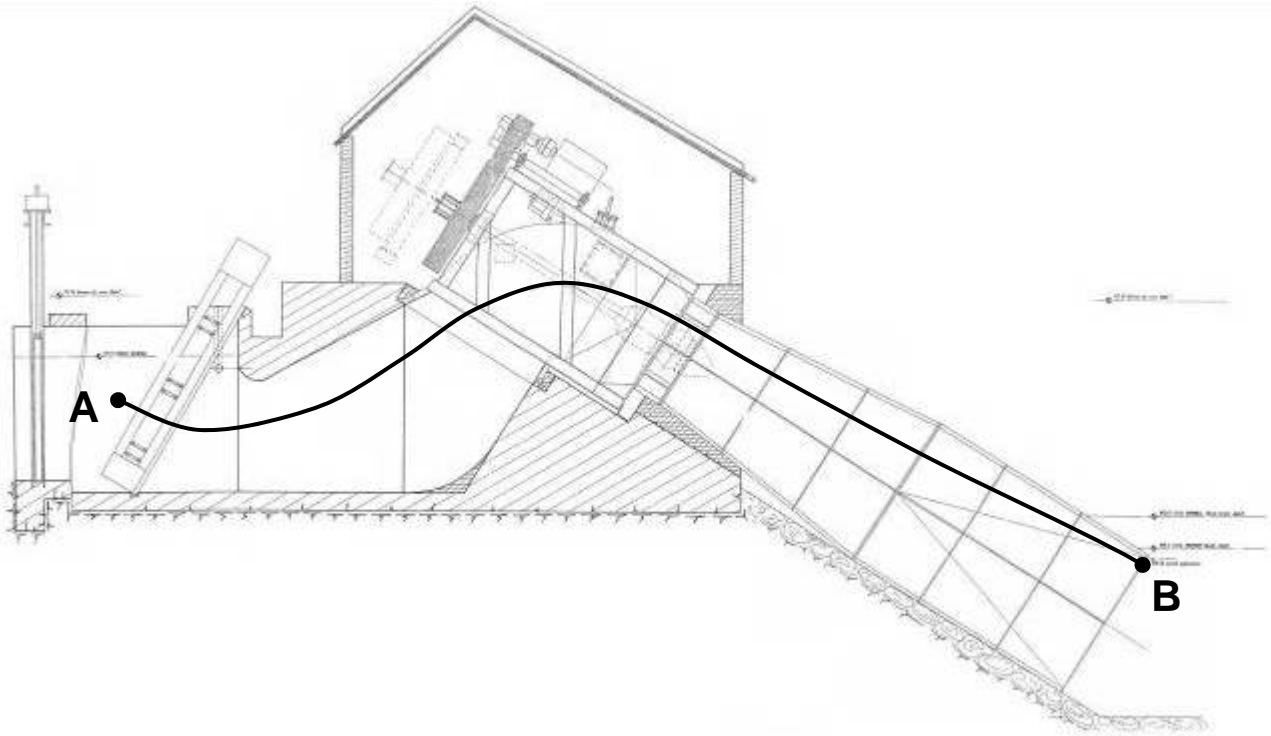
Plan d'implantation - Ligne de courant (AB)
